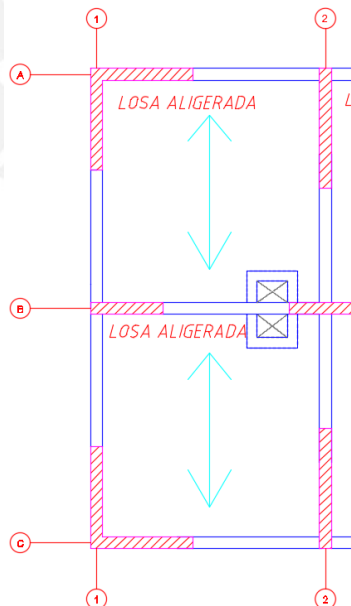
Paño de losa aligerada elegido para el metrado de cargas.
